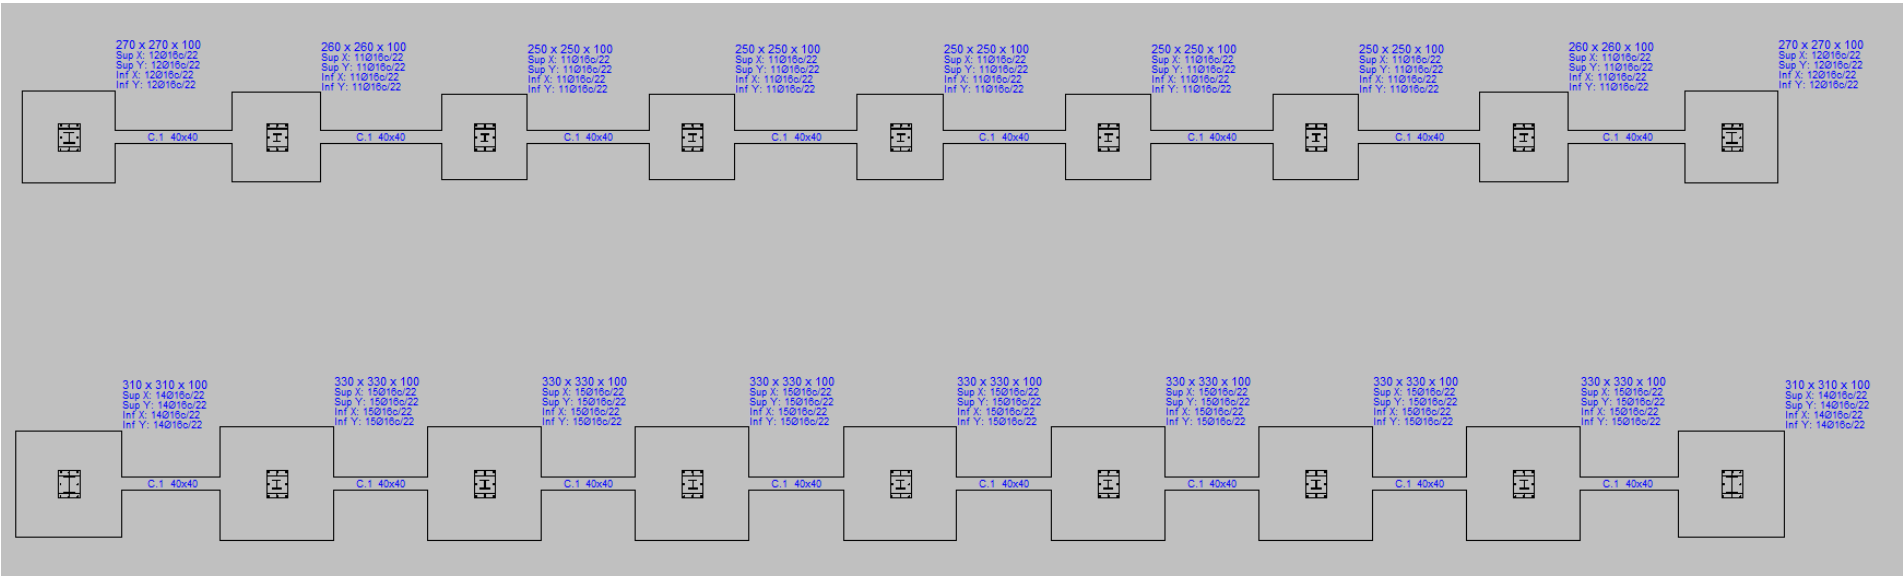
Resumen zapatas Nave 1. Fuente Cype2019
